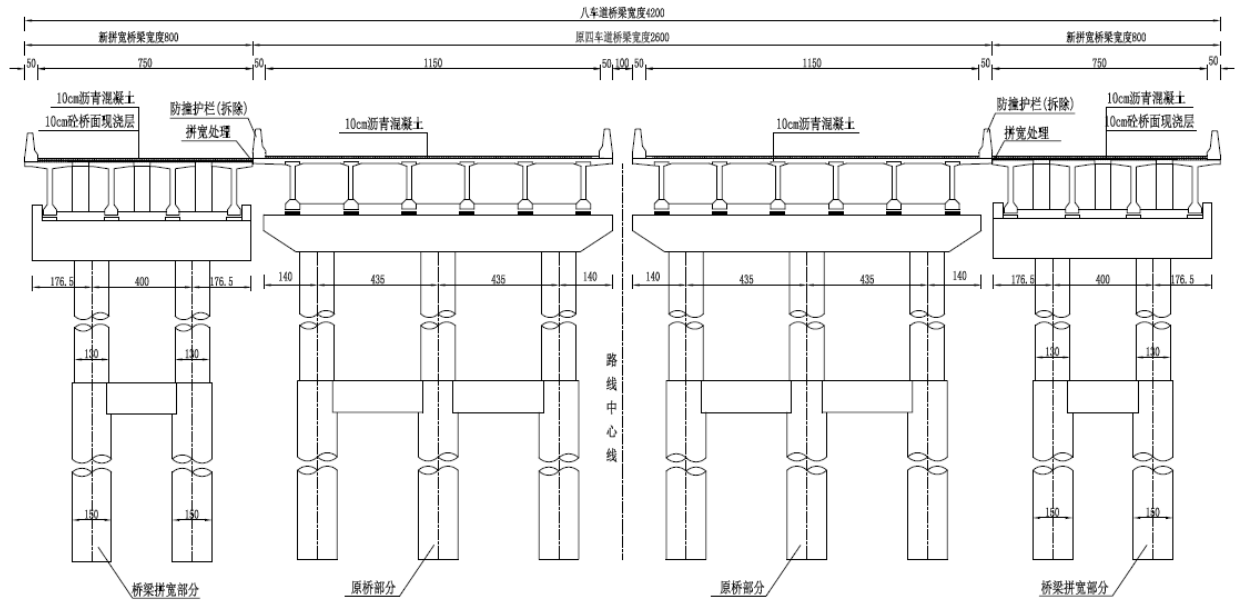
T 型组合桥梁加宽标准横断面图 (26m—42m)
